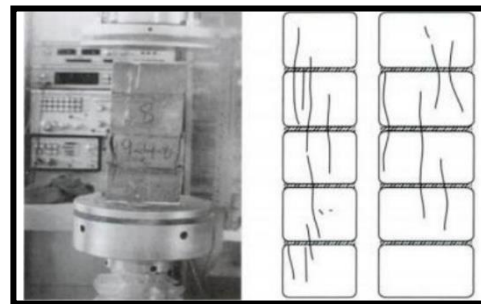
Agrietamiento típico de rotura por compresión para prismas de albañilería ensayados.
